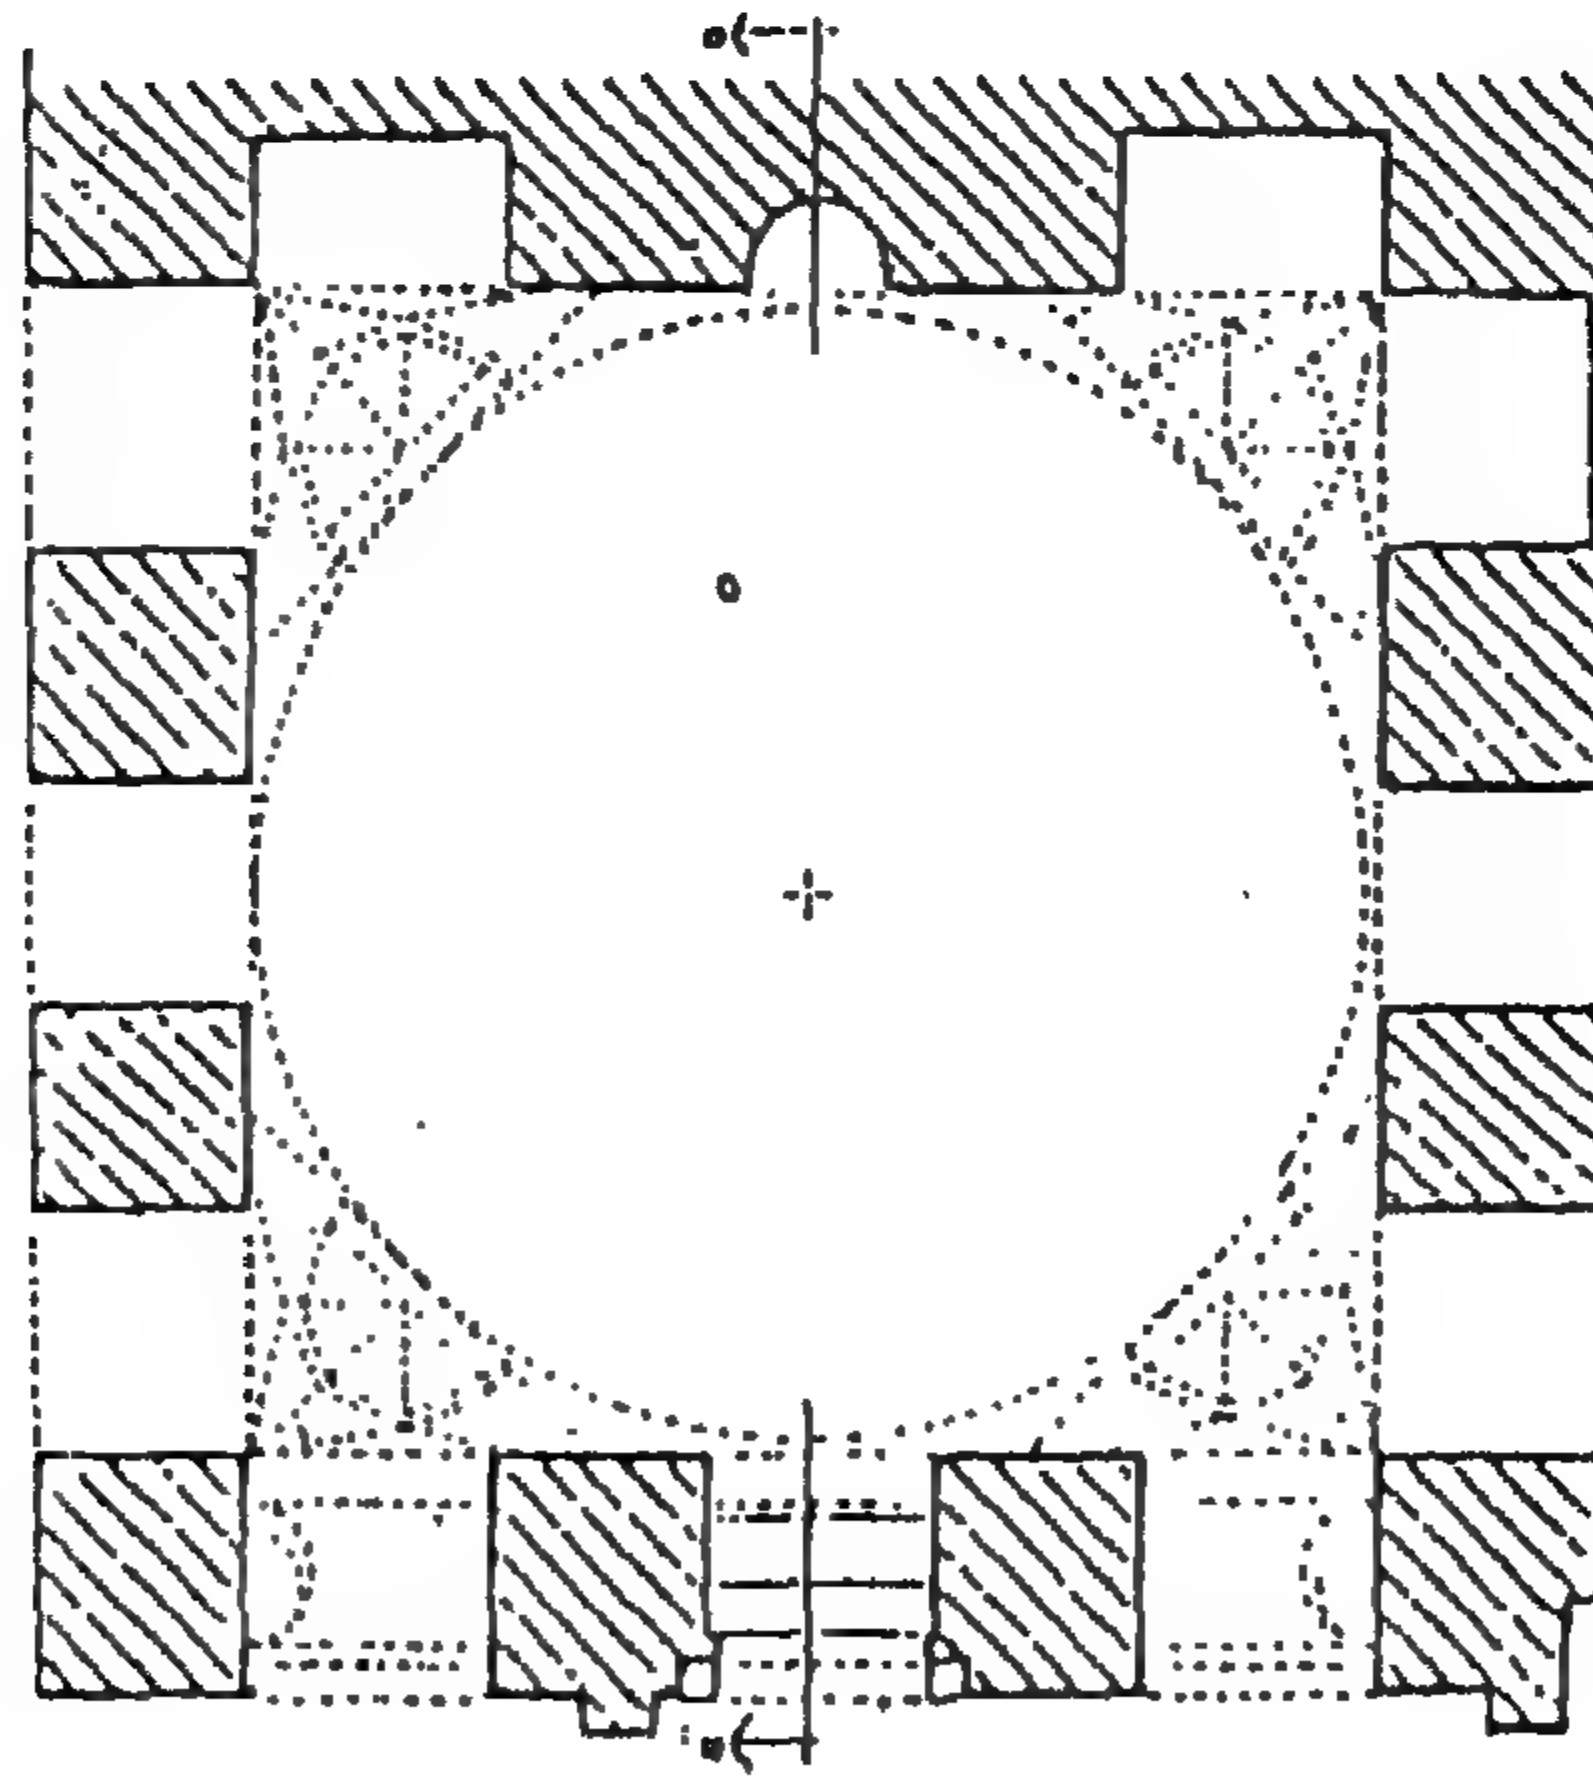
مسقط أفقي لجامع مراد باشا بالقاهرة.
